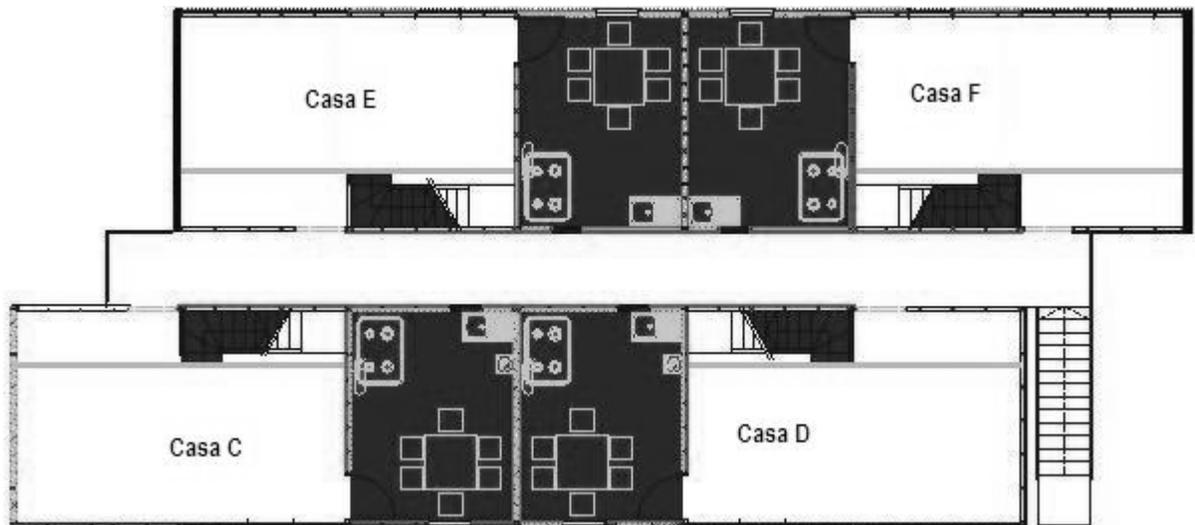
Planta Casas C, D, E, F, segundo nivel. Zona achurada superficie inicial
